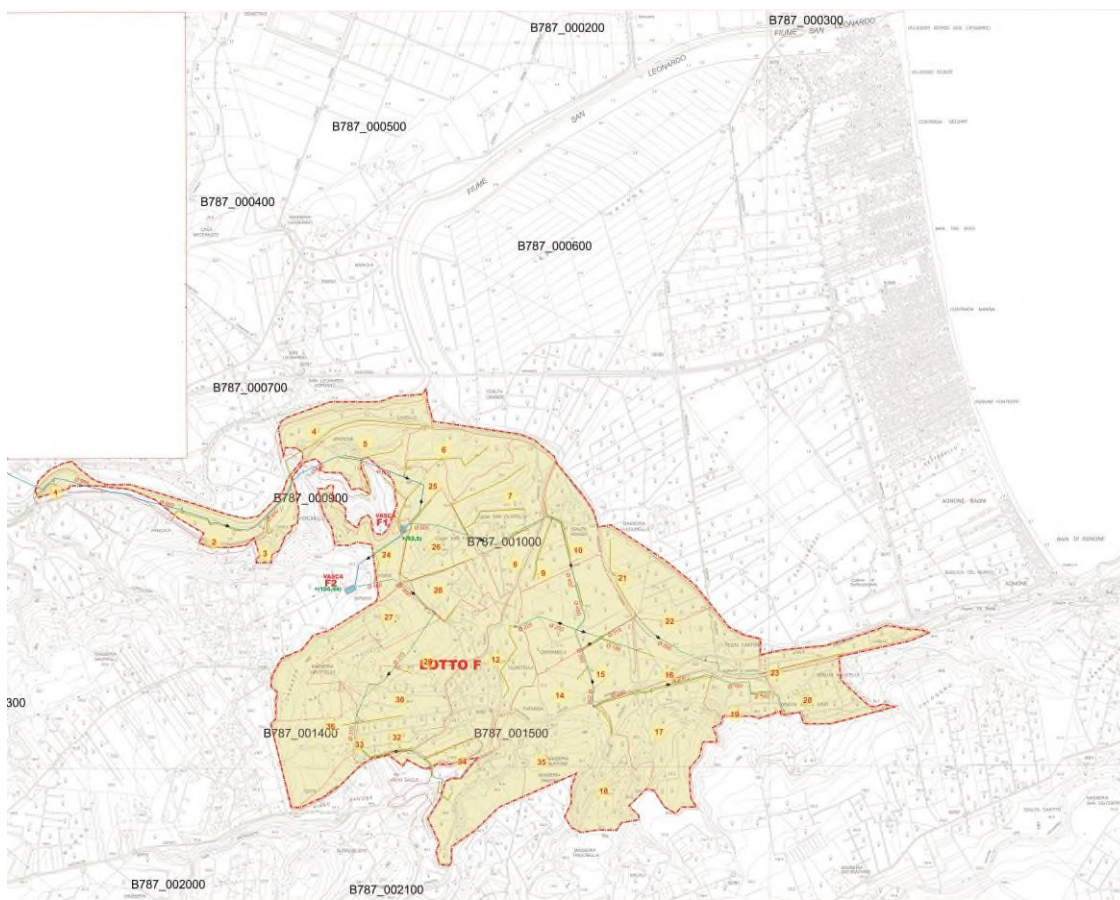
Planimetria rete irrigua lotto F con evidenziate in giallo le tubazioni terziarie
